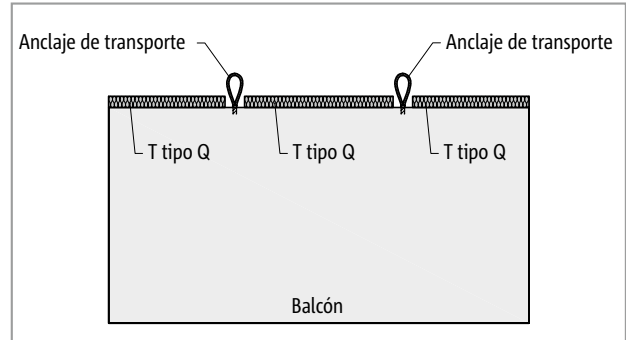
Schöck Isokorb® T tipo Q: Balcón de elementos con anclaje de transporte; en obra se puede colocar el adaptador aislante T tipo Z
